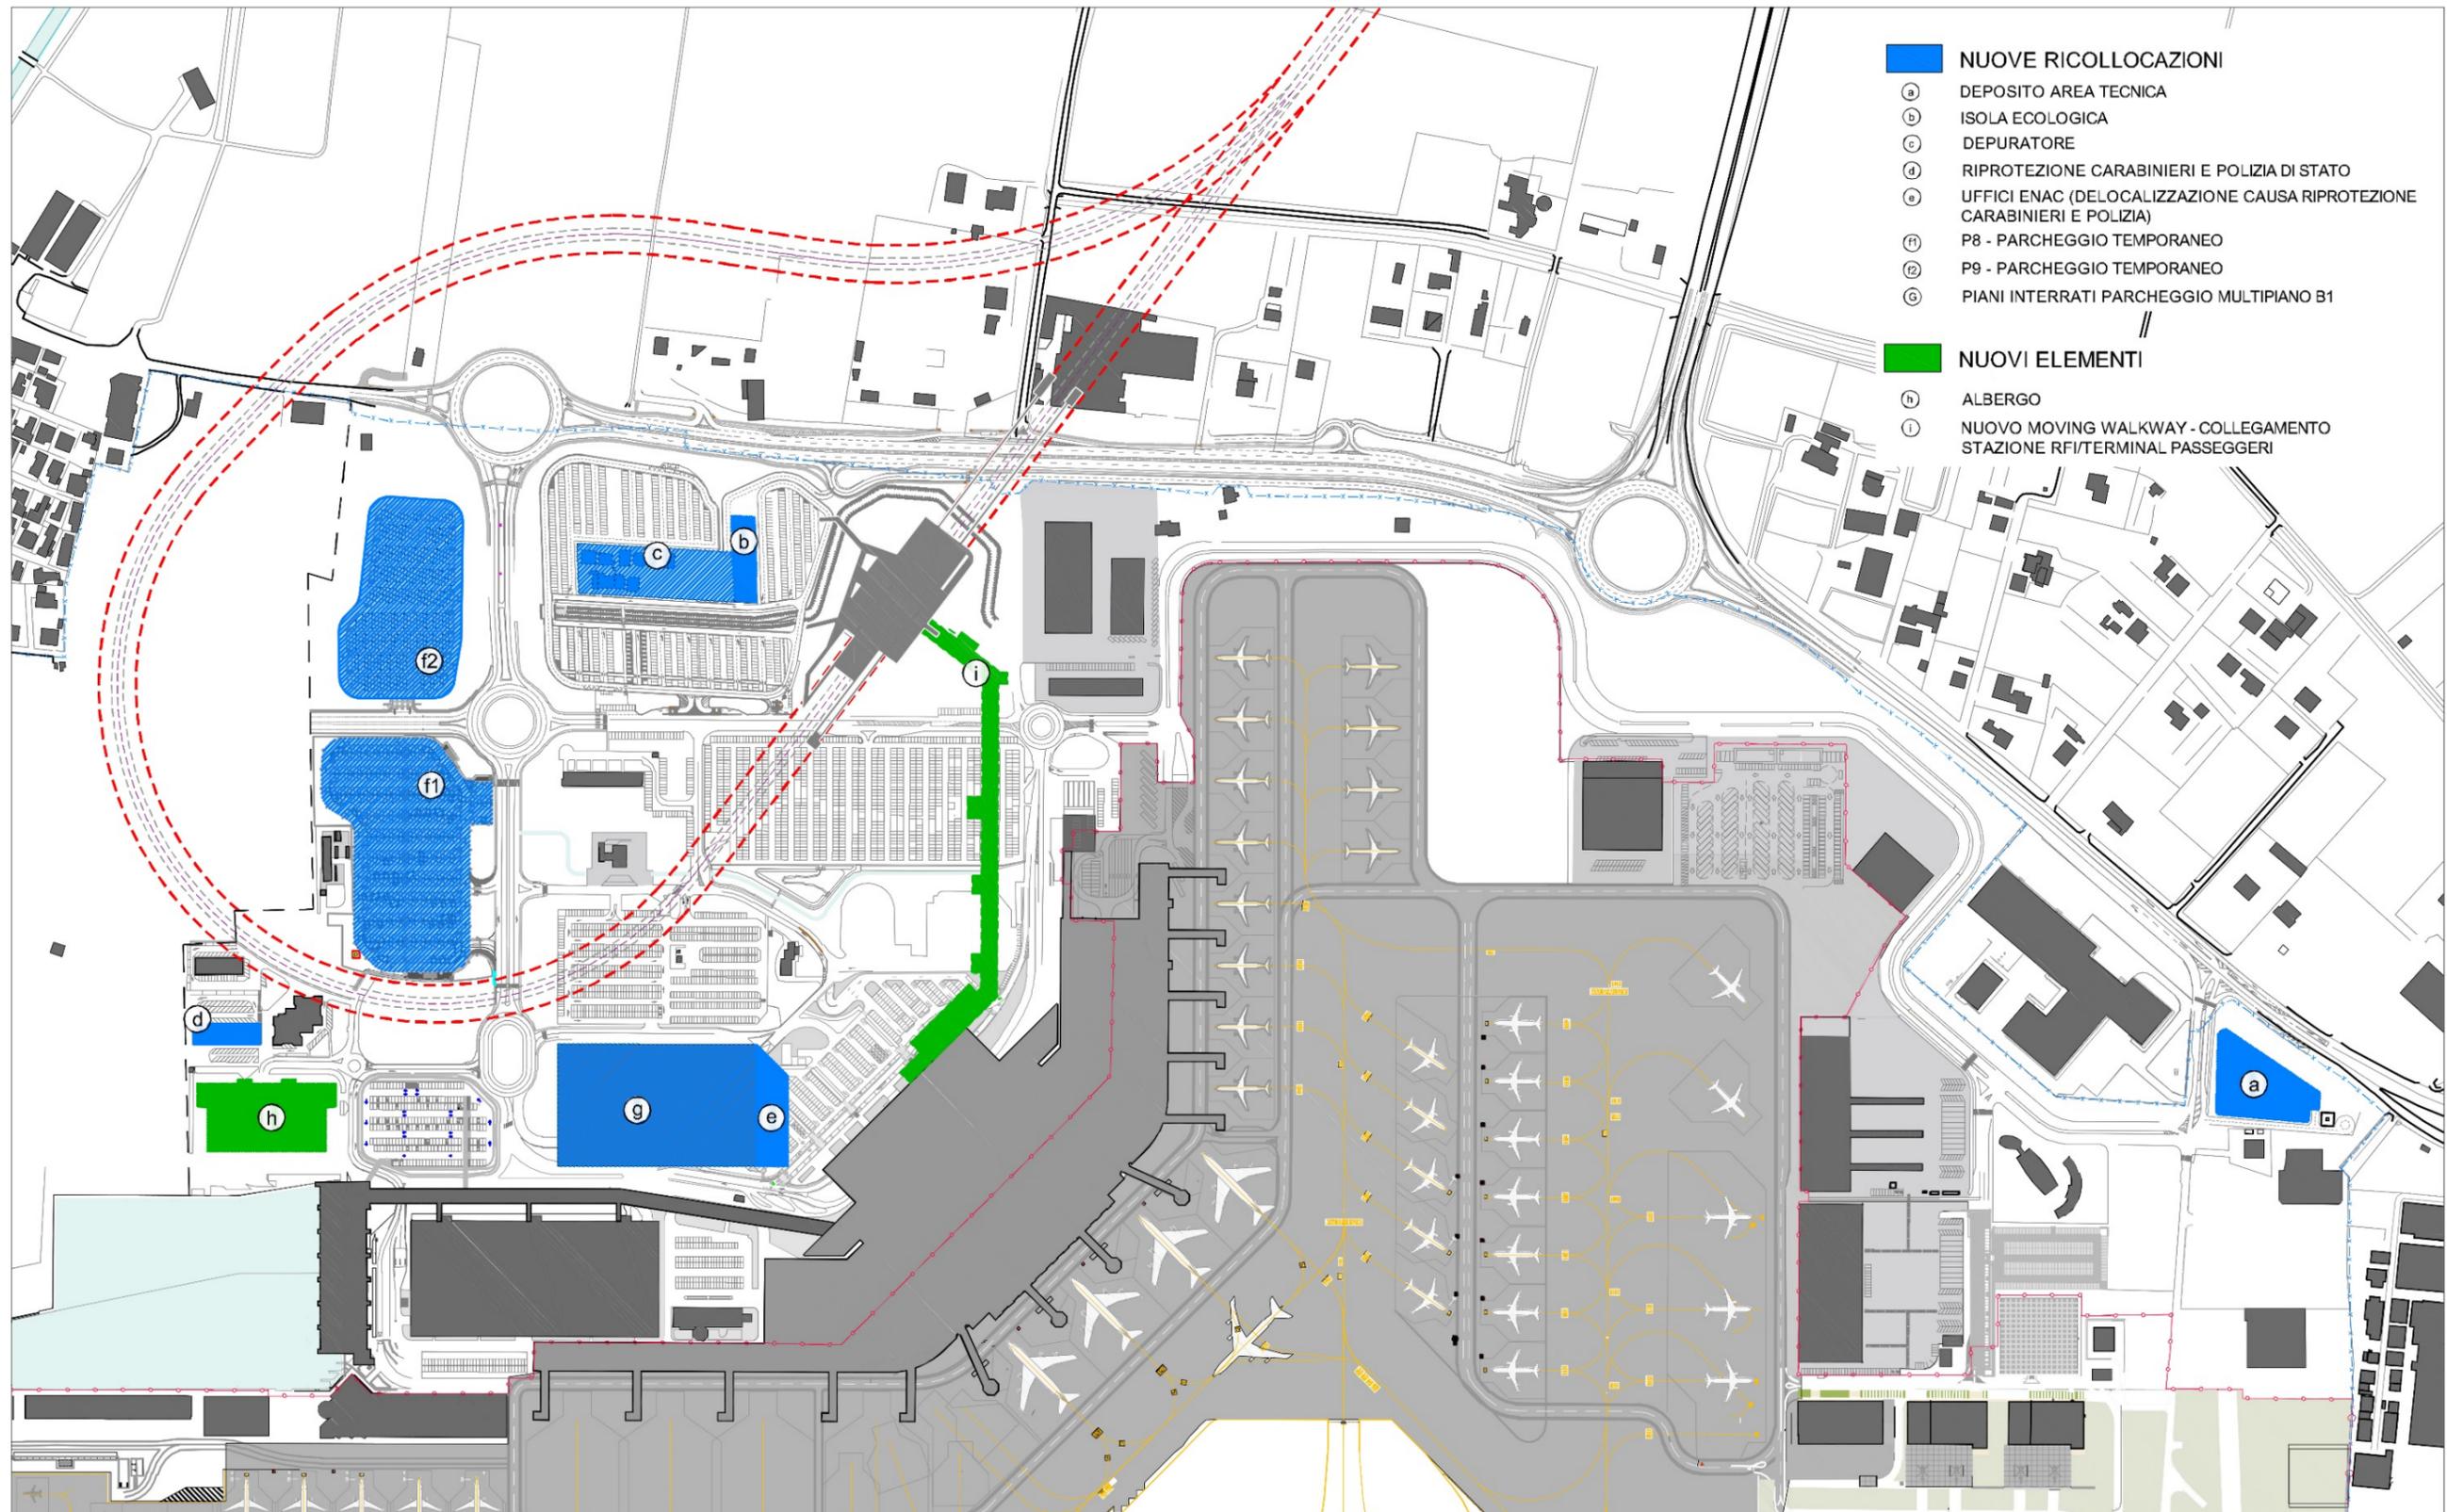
Planimetria di inquadratura degli interventi in Variante al Master Plan 2021
